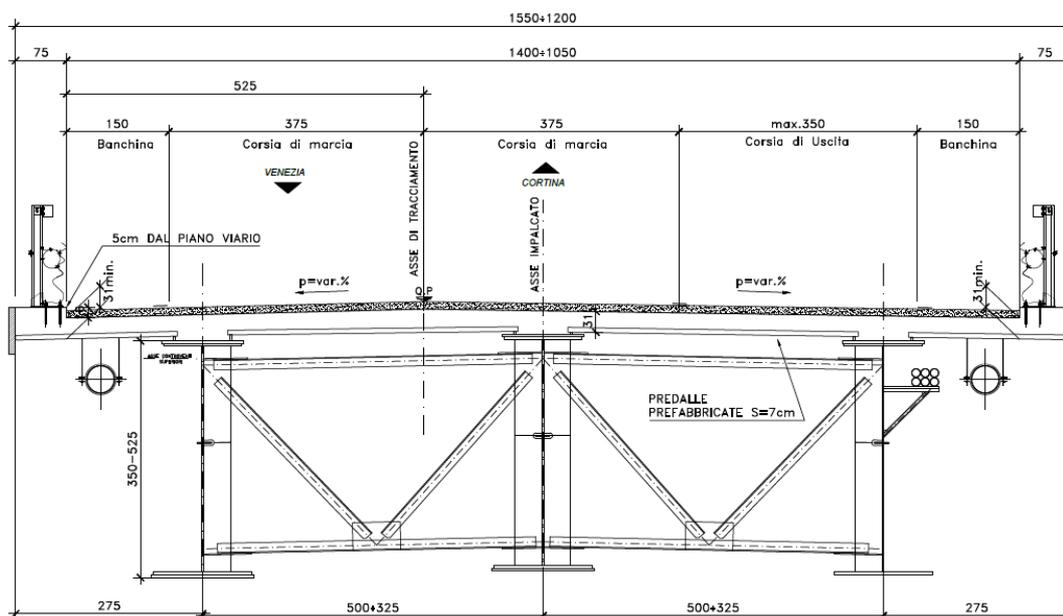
Sezione trasversale impalcato tra pila P4 e spalla SPB.
